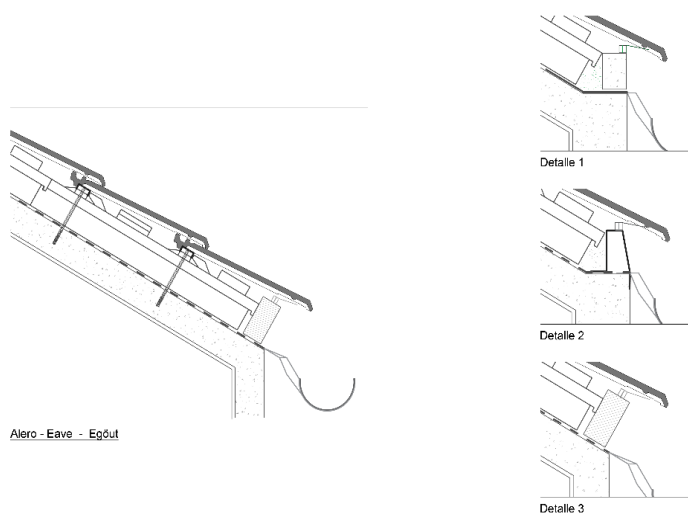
Paso 2: Instalación de placas λSAT y de rastreles metálicos
